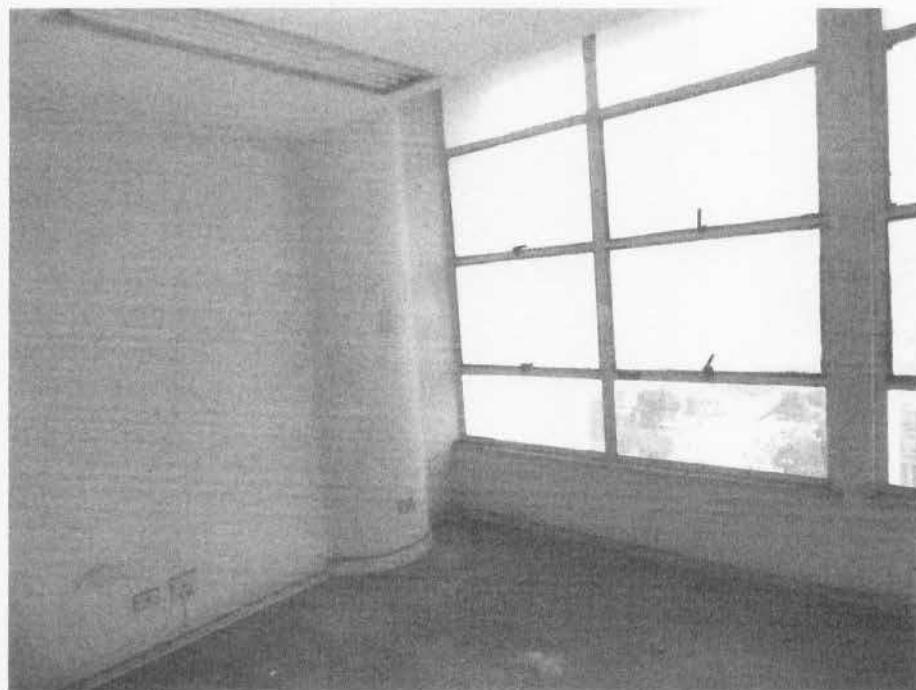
Vista da sala 2 do conjunto comercial 2.410, com trincas nas paredes.
